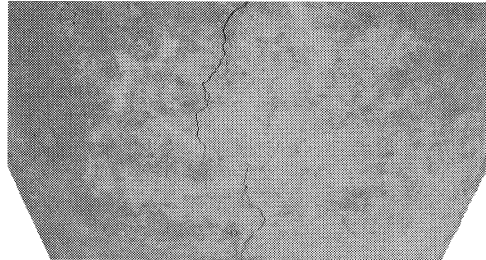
底面のひび割れ発生状況 (H-A)
